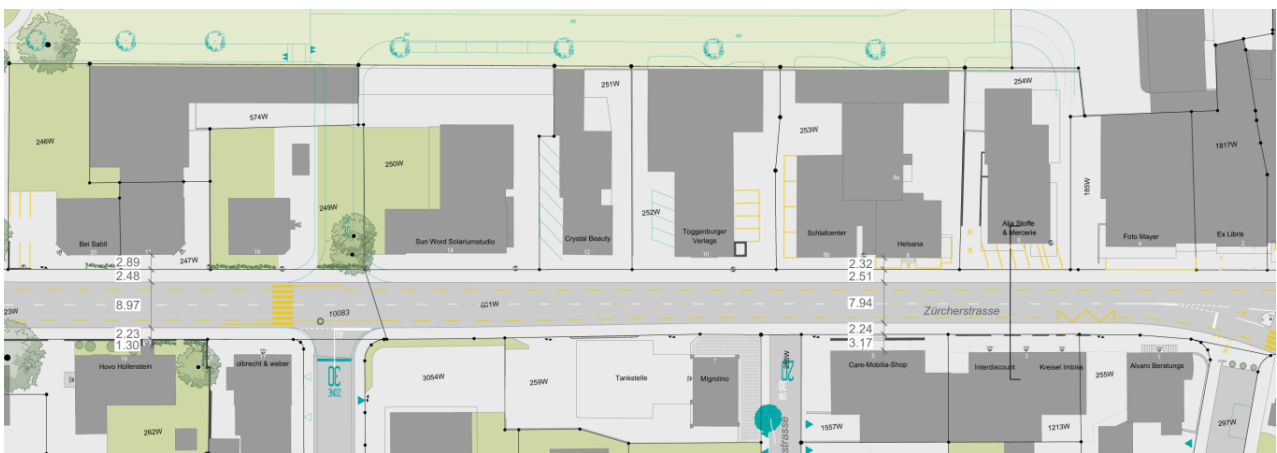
Ausschnitt Bestandesplan mit bestehenden Parkplätzen (verkleinert)
